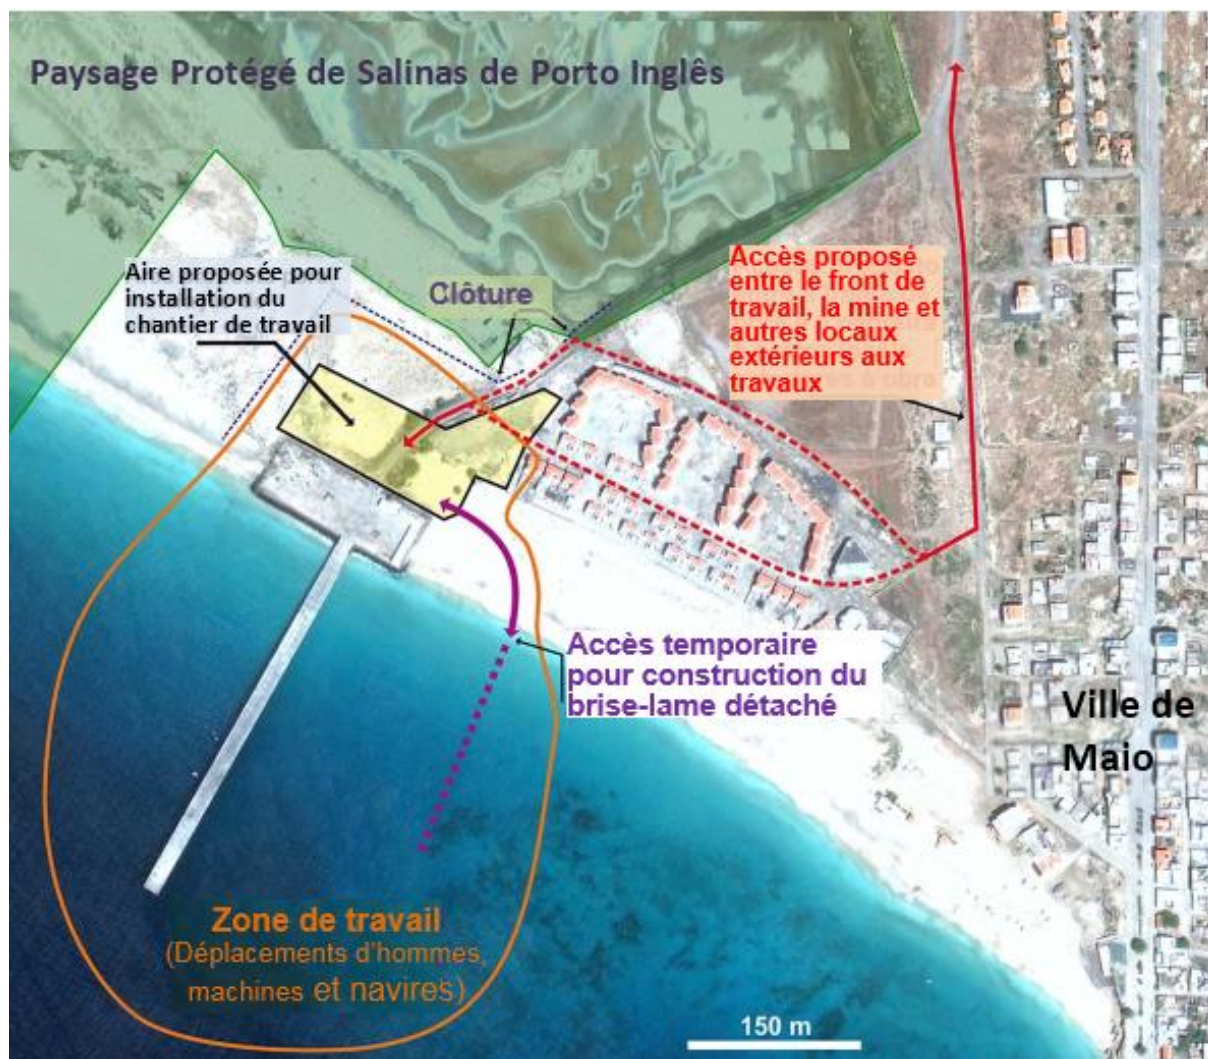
Emplacement proposé pour l'installation du chantier et l'accès au site
